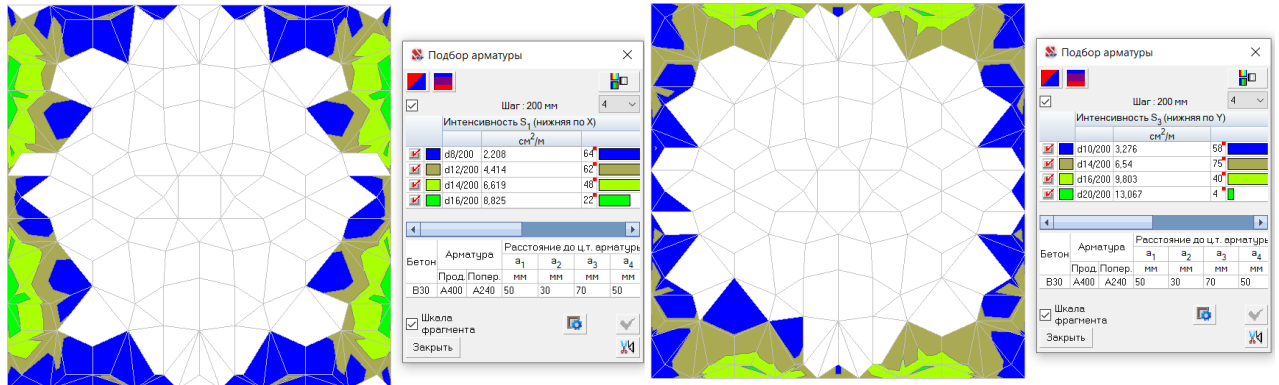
Требуемые диаметры верхней арматуры ростверка фундамента под колонны
